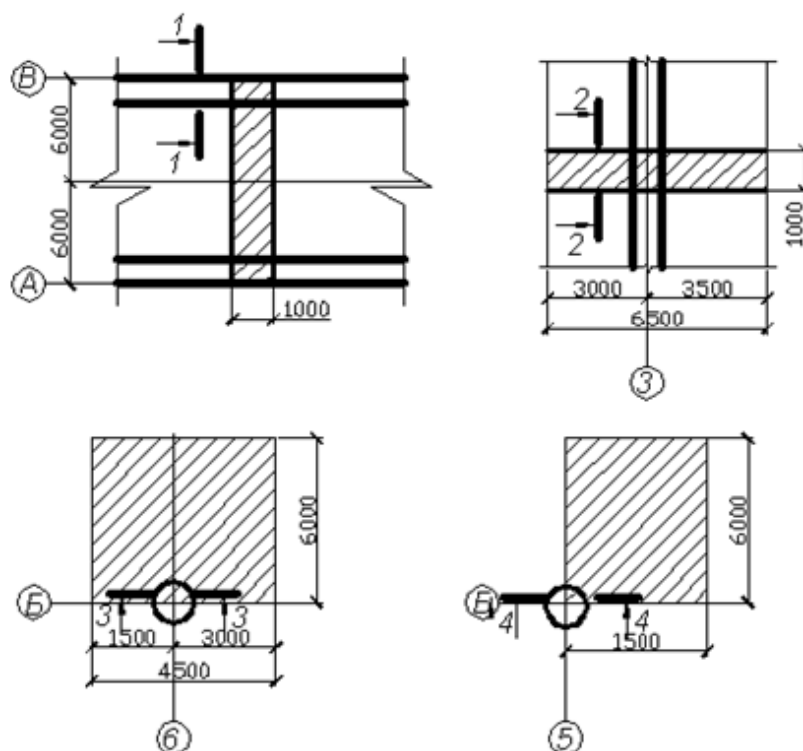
Площа розподілу навантажень на фундамент
